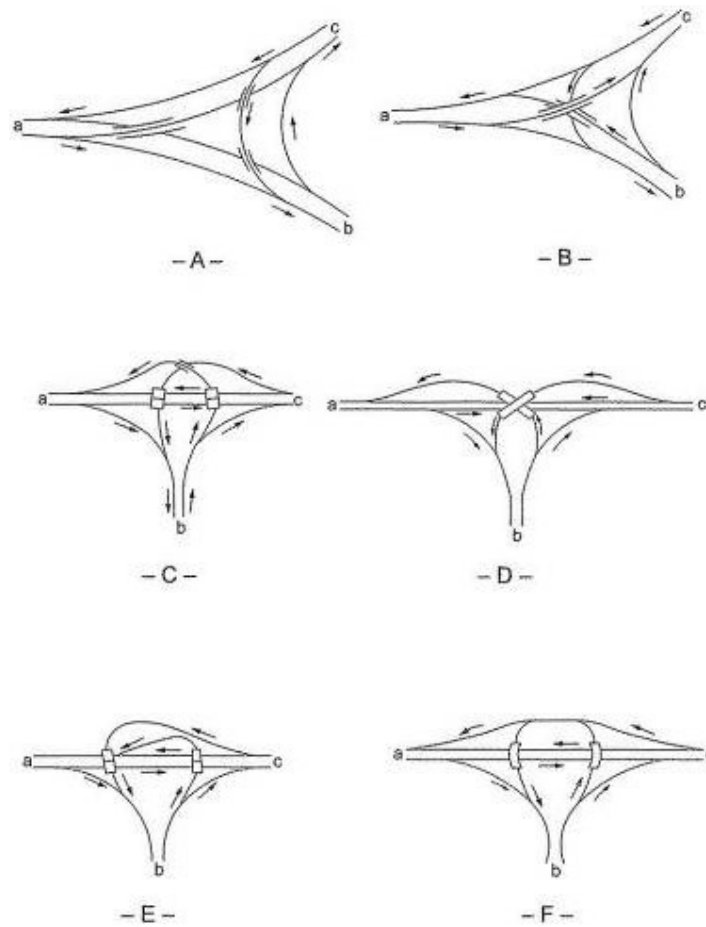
Distribuidores de tres ramales con estructuras múltiples
